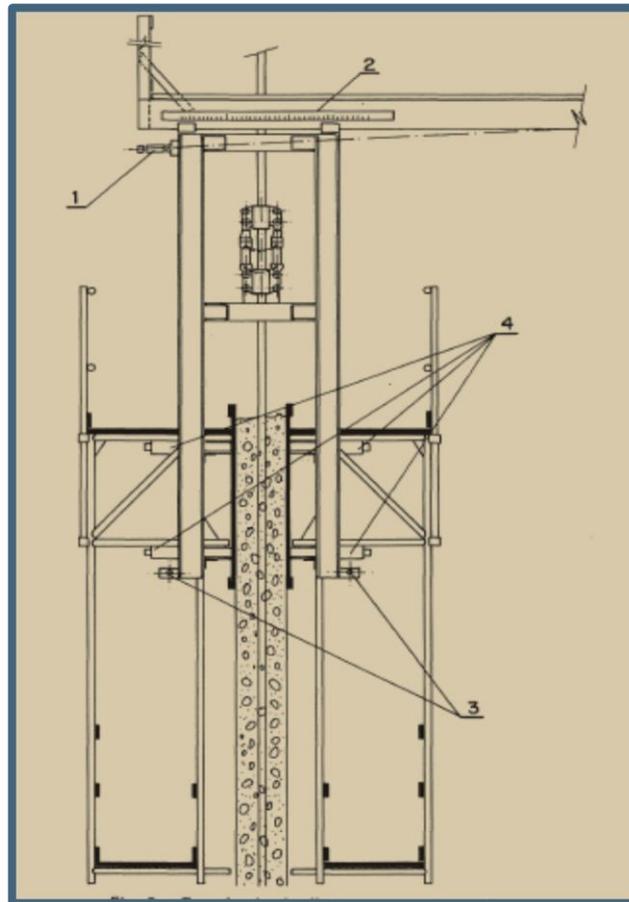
Encofrado Deslizante para Construcciones de Sección Variable.
